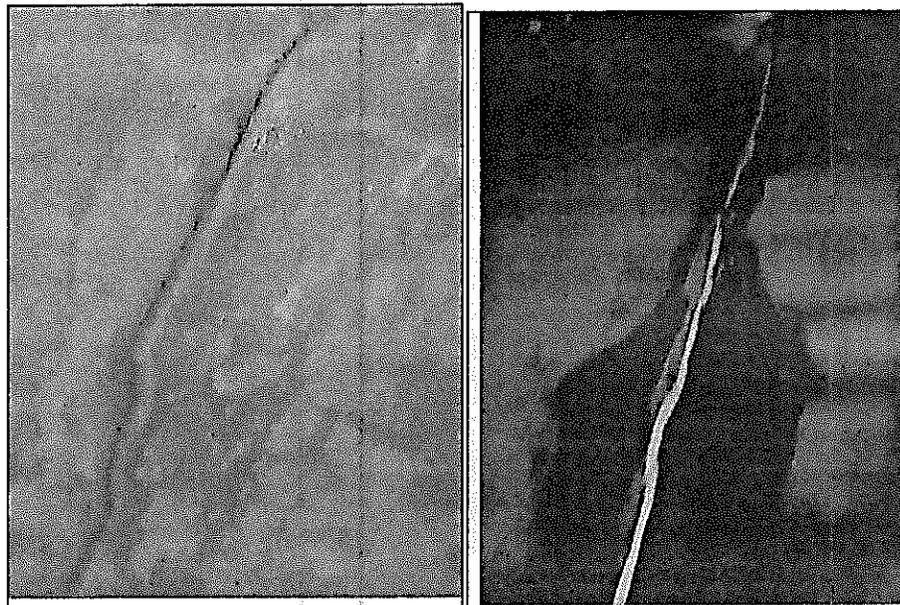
(Izq.) Grieta en el muro de 5 mm en toda su altura. (Der) grieta en el sentido longitudinal en los muros norte y oeste rellena con material plástico – flexible, desprendimiento lechada. "fuente propia"
